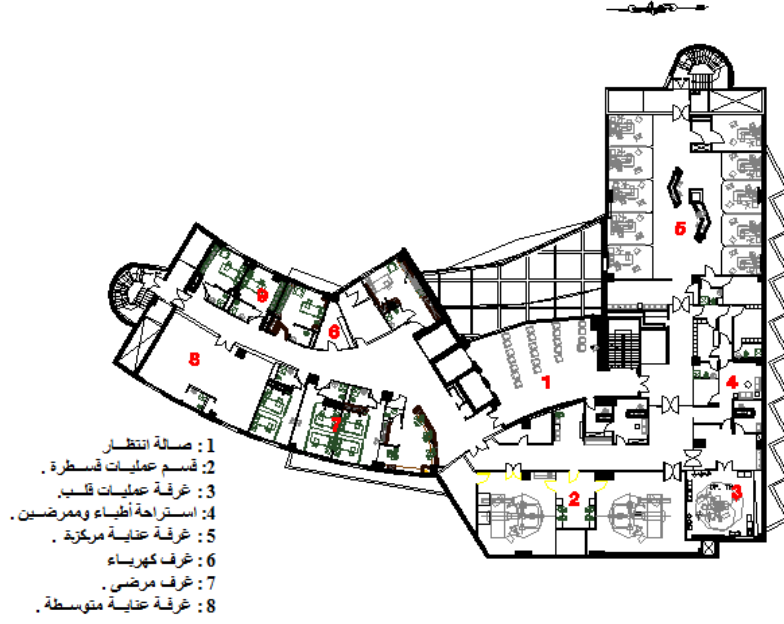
مسقط الطابق الأرضي للمستشفى .
